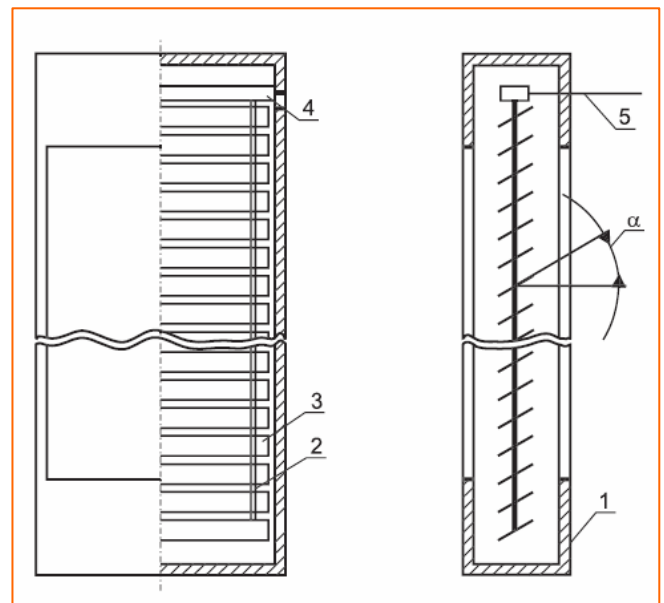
Конструкция оконного блока с теплоотражающими непрозрачными металлическими жалюзи: 1 – корпус; 2 – направляющие; 3 – алюминиевый поворотный элемент; 4 – крепление; 5 – управляющий тросик; α – угол наклона поворотных элементов жалюзи относительно горизонта.
